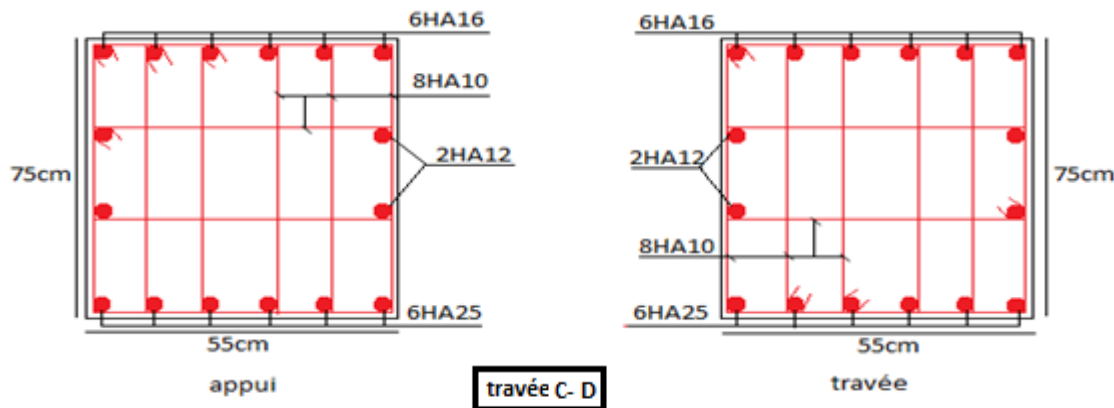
Schémas de ferrailages de poutre de rigidité (semelle sous voile .)
